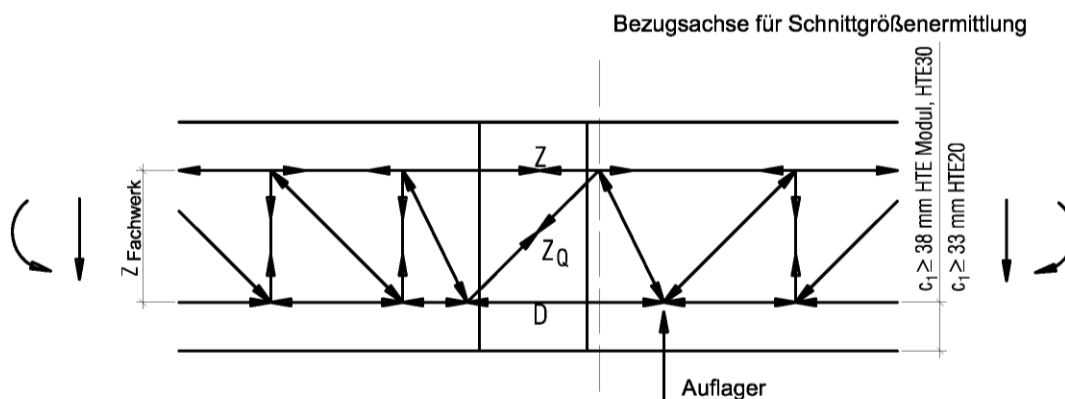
Schöck Isokorb® Typ K und KF mit Betondrucklager
